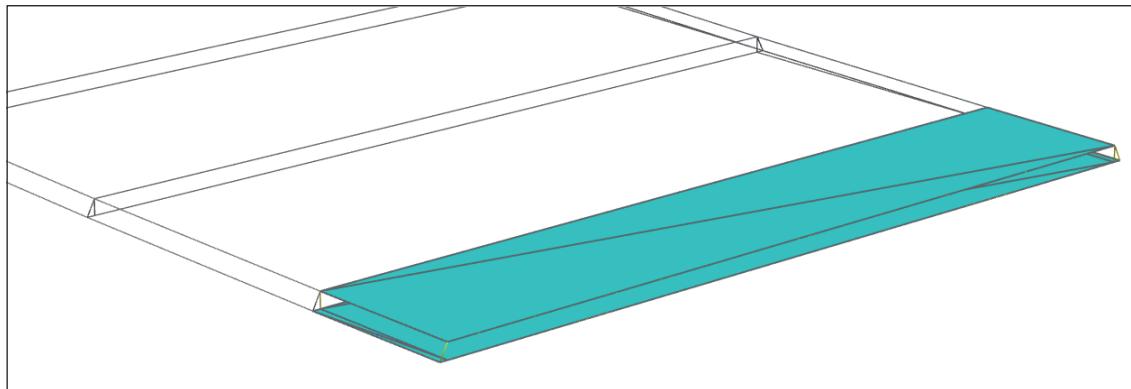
Berechnung von Deck- und Bodenflächen für ein Bauteil Asphaltdeckschicht
